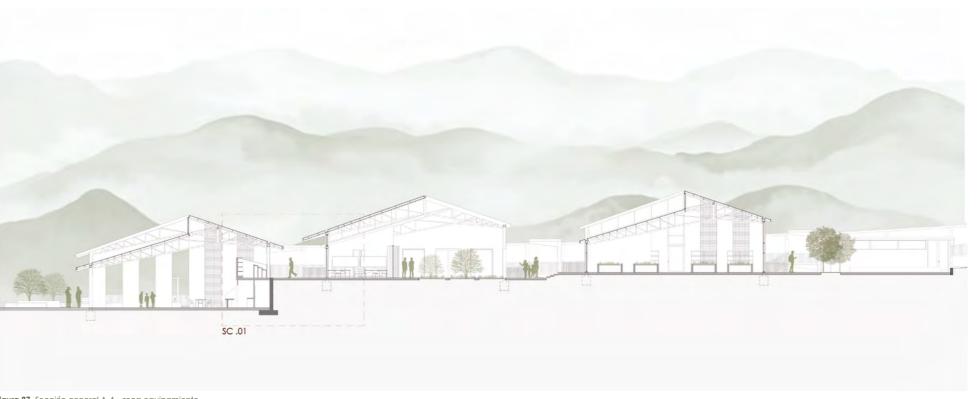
Sección general A-A - zona equipamiento Fuente: Propia
